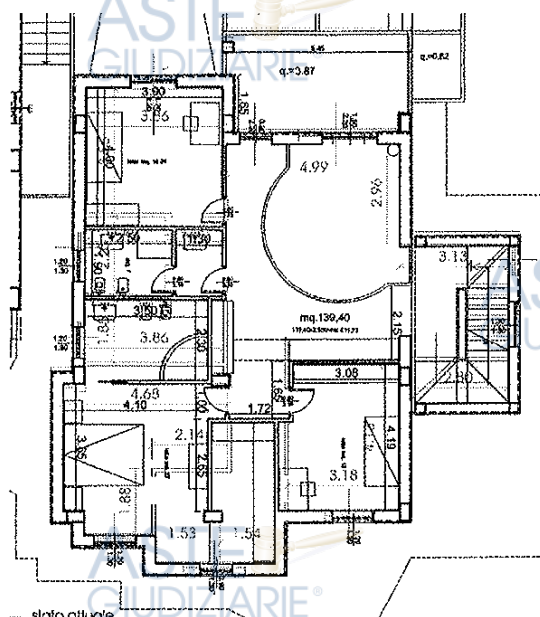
Piano sottotetto - sovrapposizione stato attuale con i disegni della Concessione edilizia
